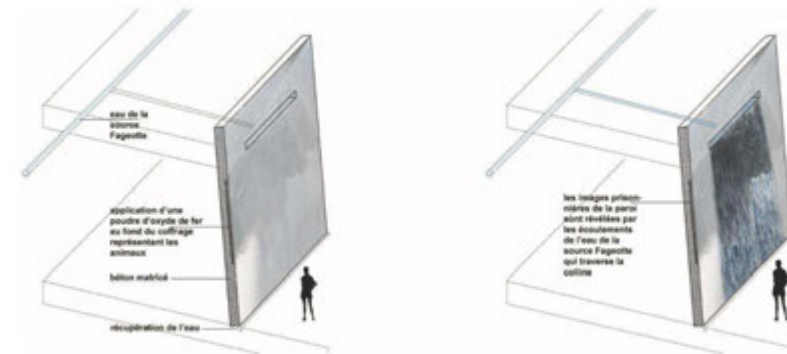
Zone d'orientation, détail de la paroi (Source : Notice architecturale APD, SNØHETTA)
